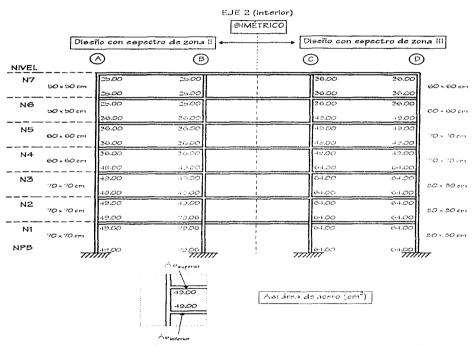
Comparación de cuantías de acero longitudinal de columnas de las estructuras disciladas en zonas II y III
